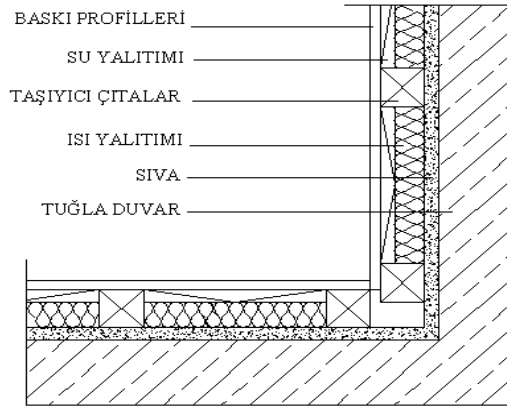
Saçak profilleri ile alın profillerinin montajı [82]
